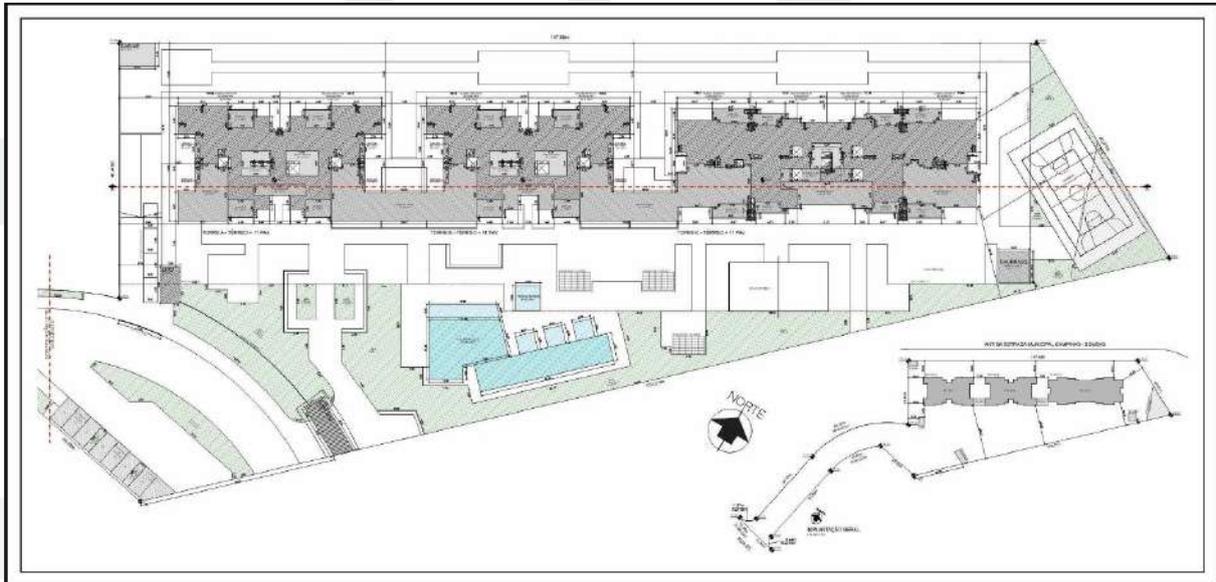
Projeto Arquitetônico pretendido - Lote 1C – Fase 2
